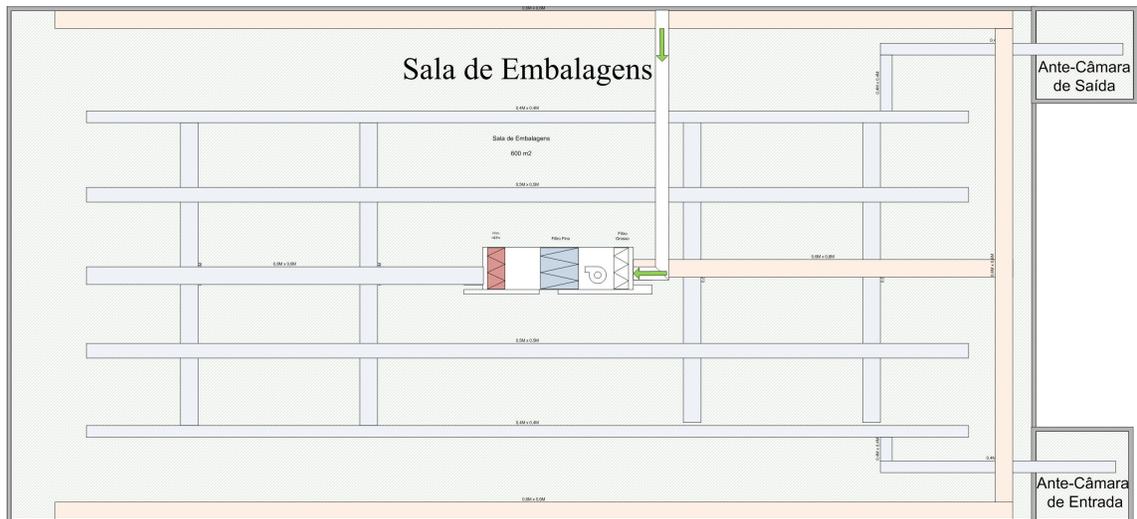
Planta Baixa do conjunto de operação das salas limpas
